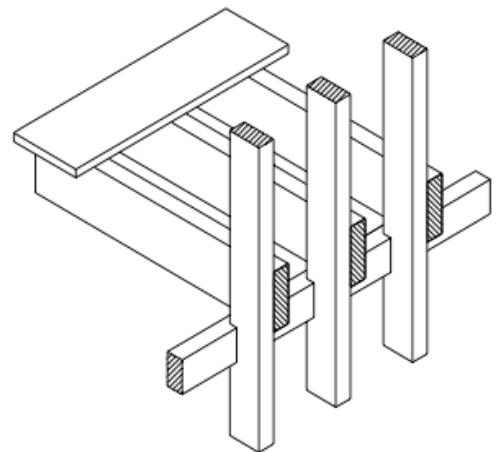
Detalle del encuentro del muro con el forjado en el sistema globo.
